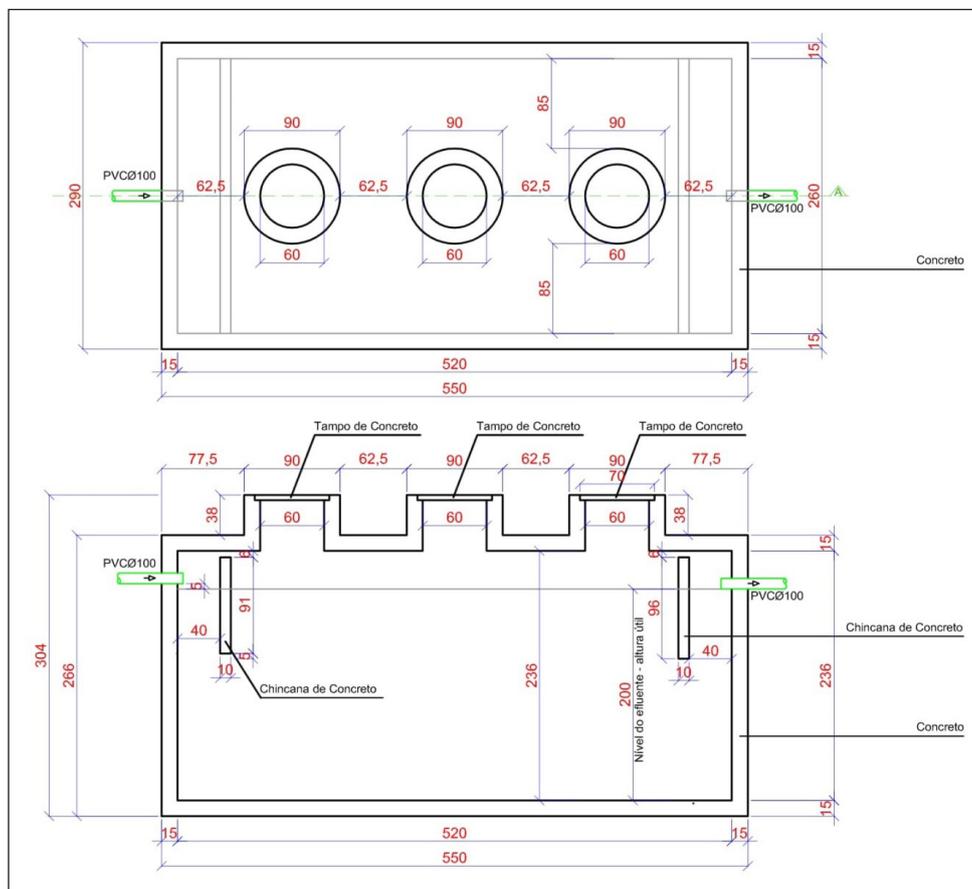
Vista en planta y sección del Tanque Séptico TS-01 (medidas en cm)
